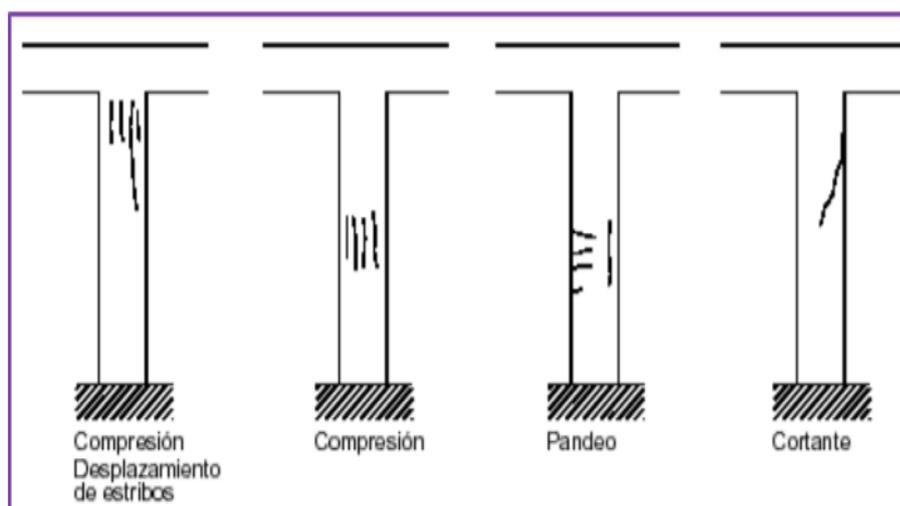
FISURACIÓN POR COMPRESIÓN
